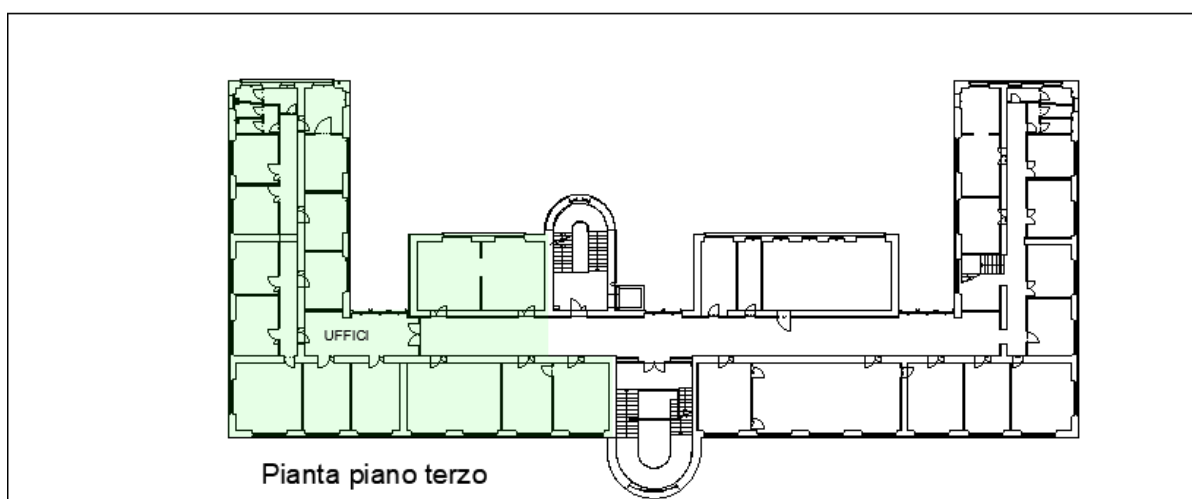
Spazi da assegnare alla Ragioneria provinciale dello Stato - piano terzo
